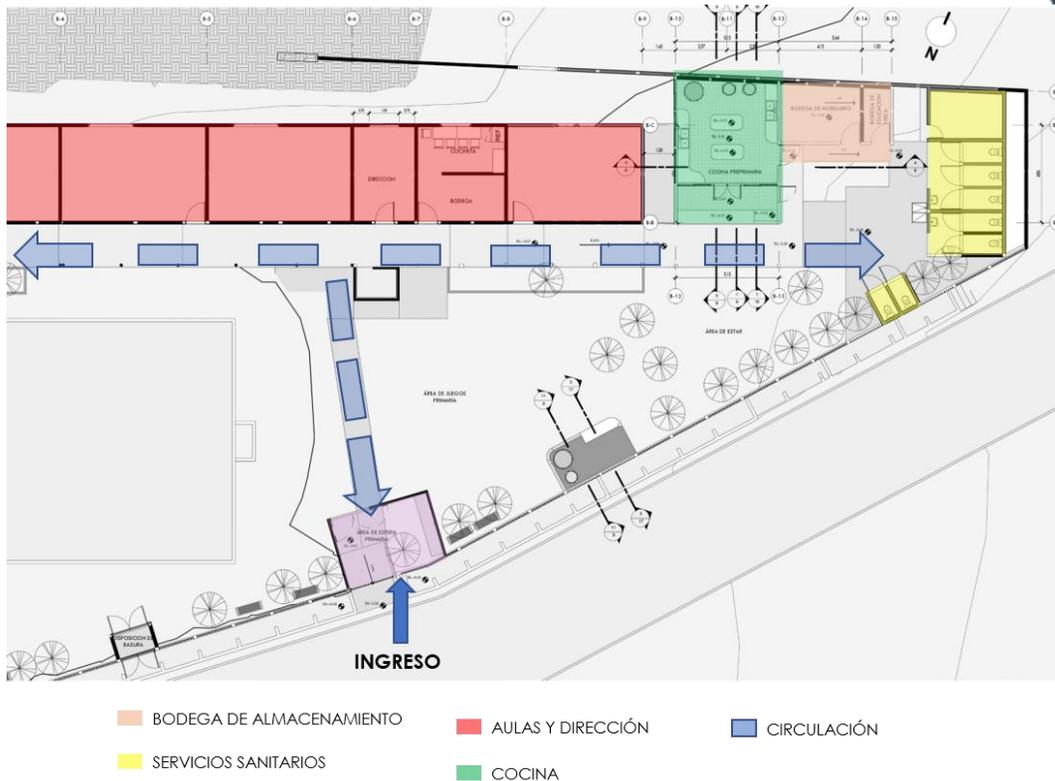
Planta de Primaria Sectorizada. Fuente: Archivo Infraestructura DES.
